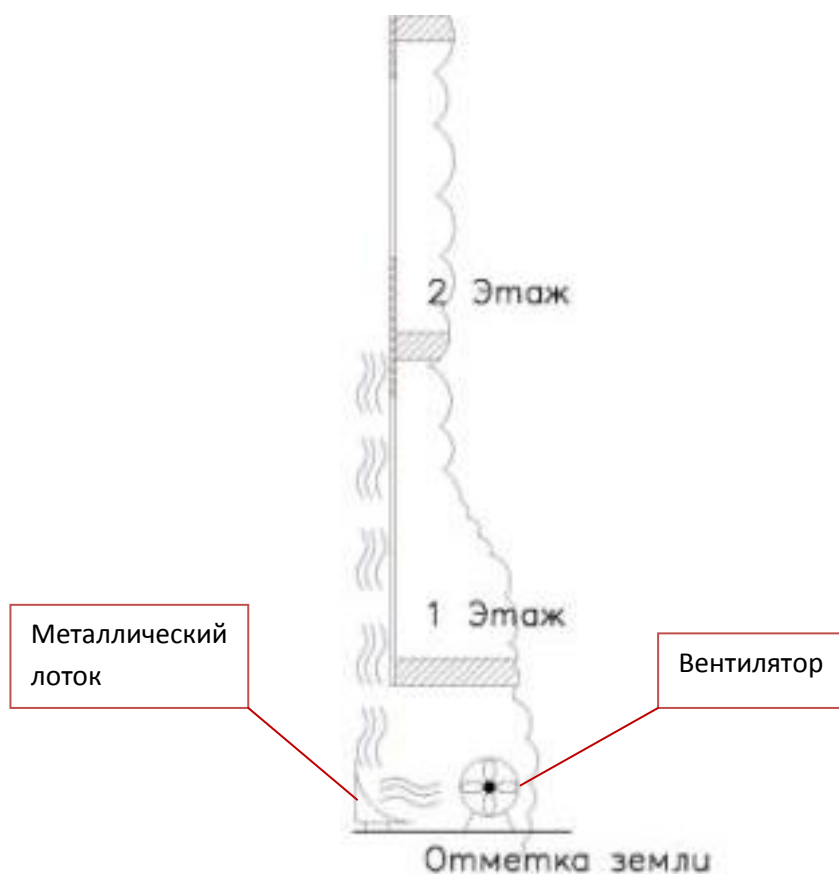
Схема размещения оборудования для создания ветровых потоков вдоль фасада здания
